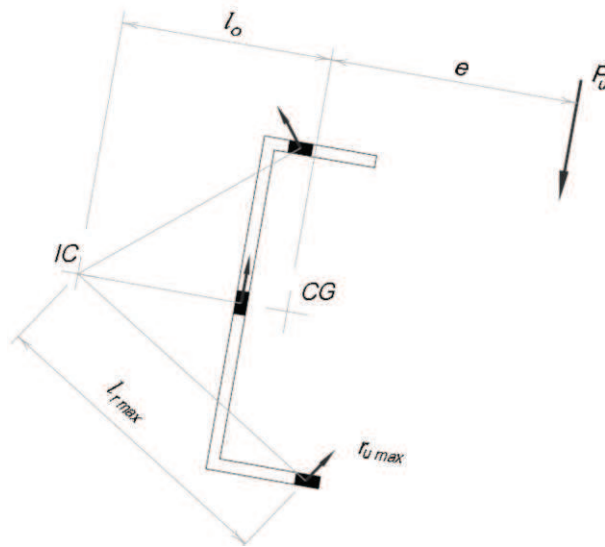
Diagrama de fuerzas sobre la soldadura
